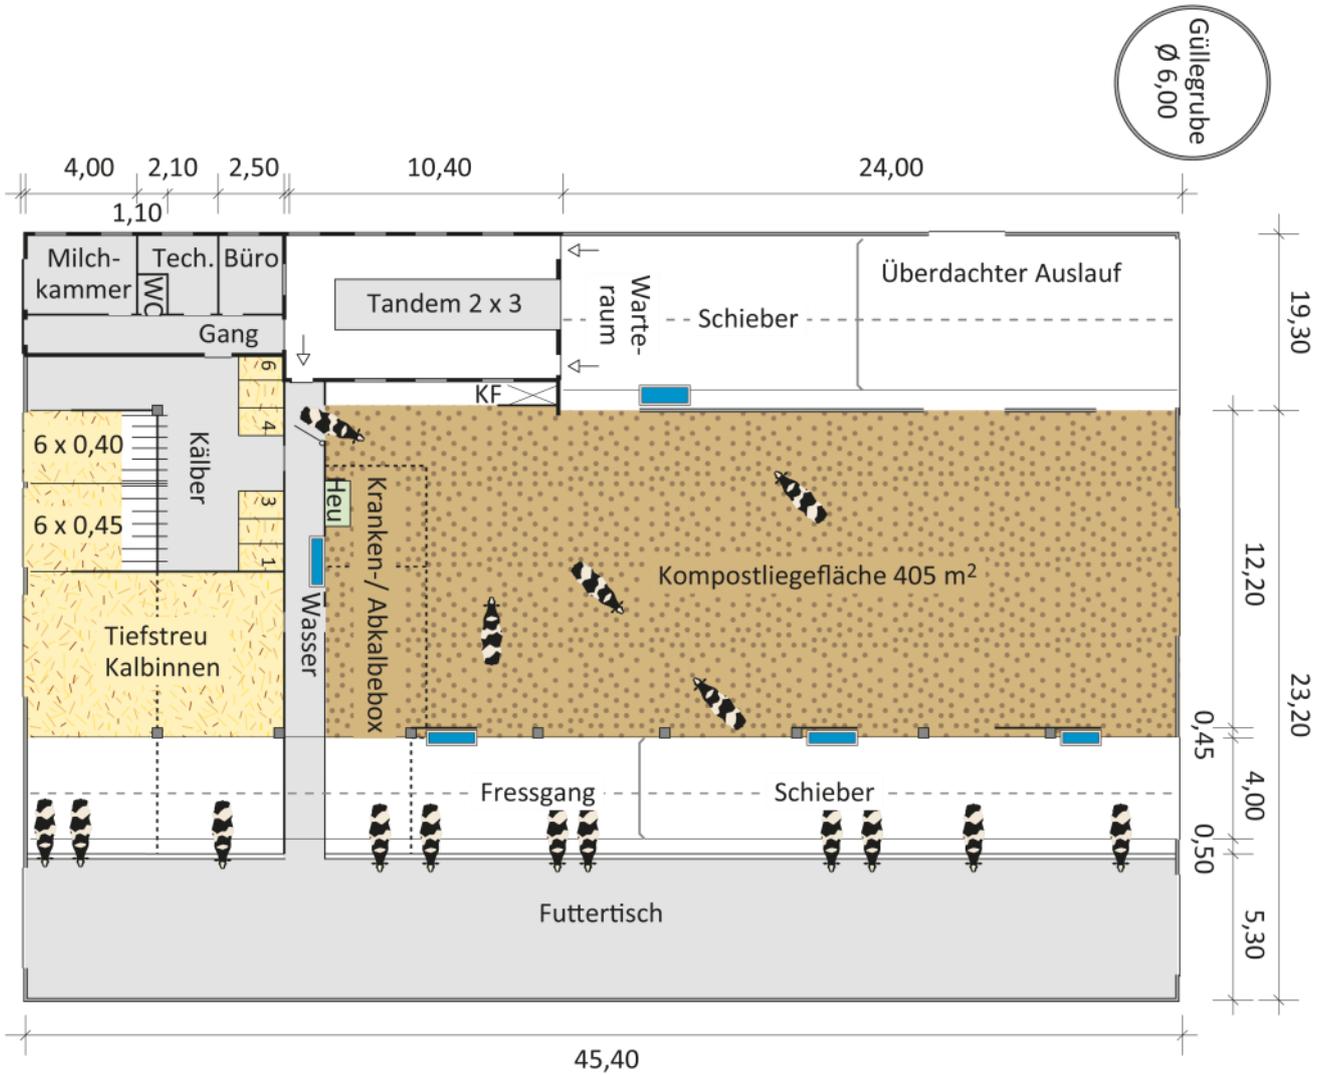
Grundriss - Betrieb Oberholzner
